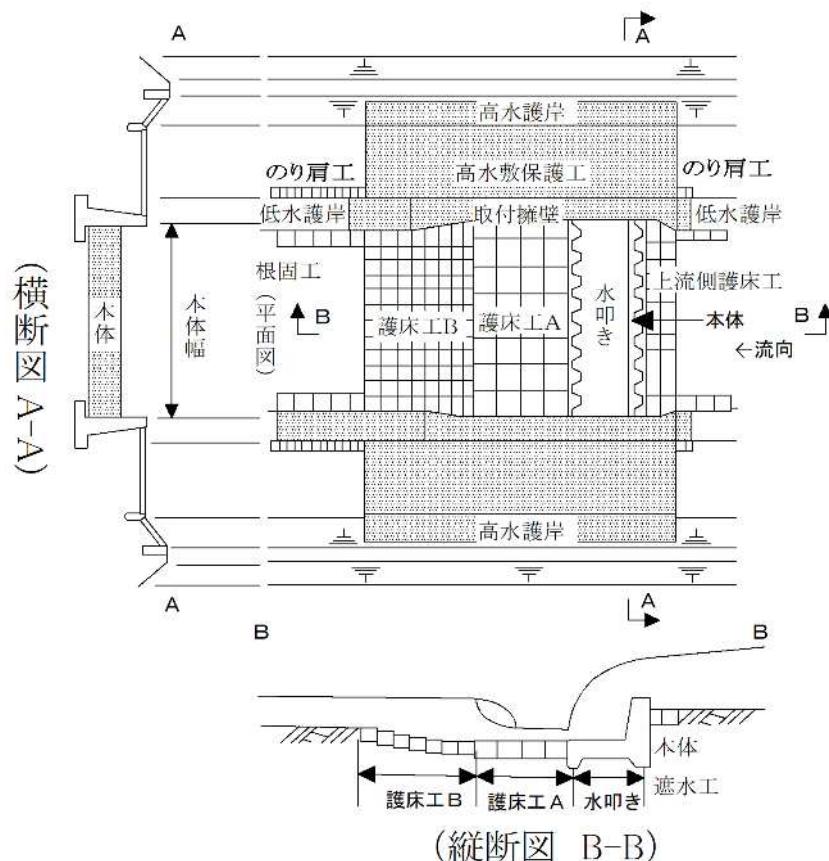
床止めの各部位の名称（コンクリート構造の場合）
